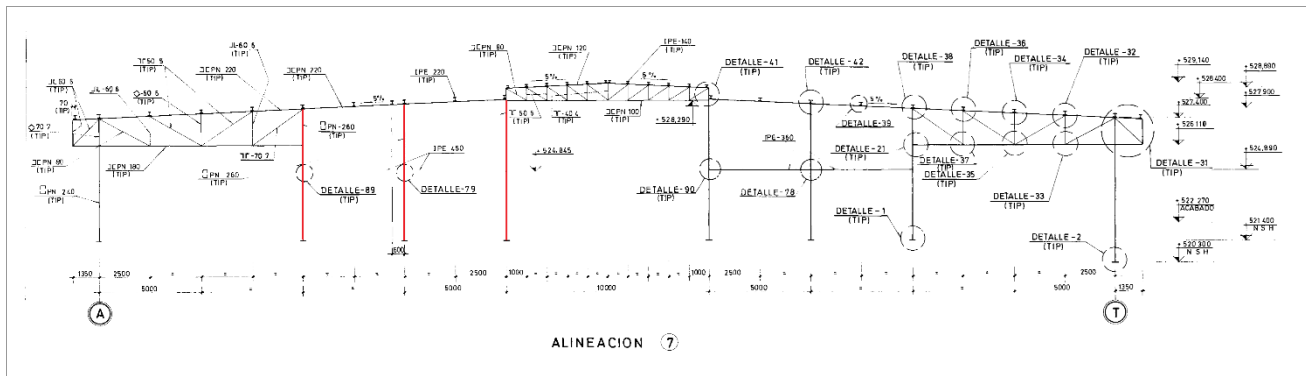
Estructura metálica – Modificación del pórtico en alineación 7
